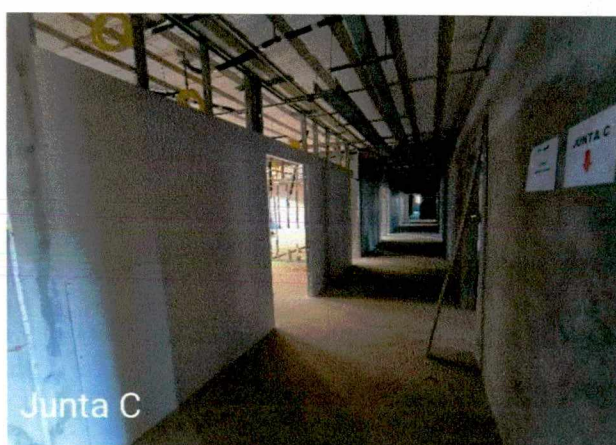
a 5: Execução de instalações (gases medicinais, climatização, hidrossanitário e incêndio); montagem de drywall; montagem da estrutura metálica; impermeabilização das calhas.
